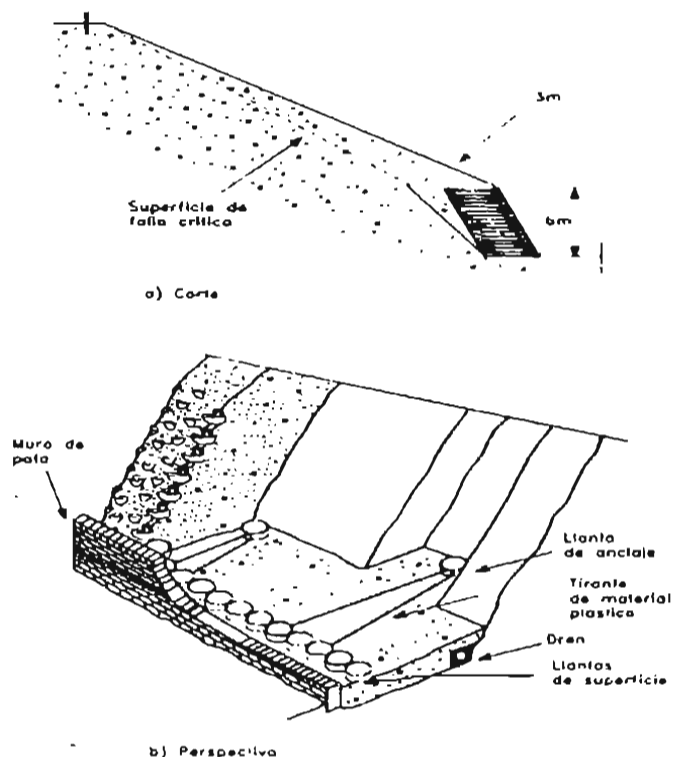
Muro armado con llantas usadas, utilizando llantas con tirantes como elemento de anclaje.
